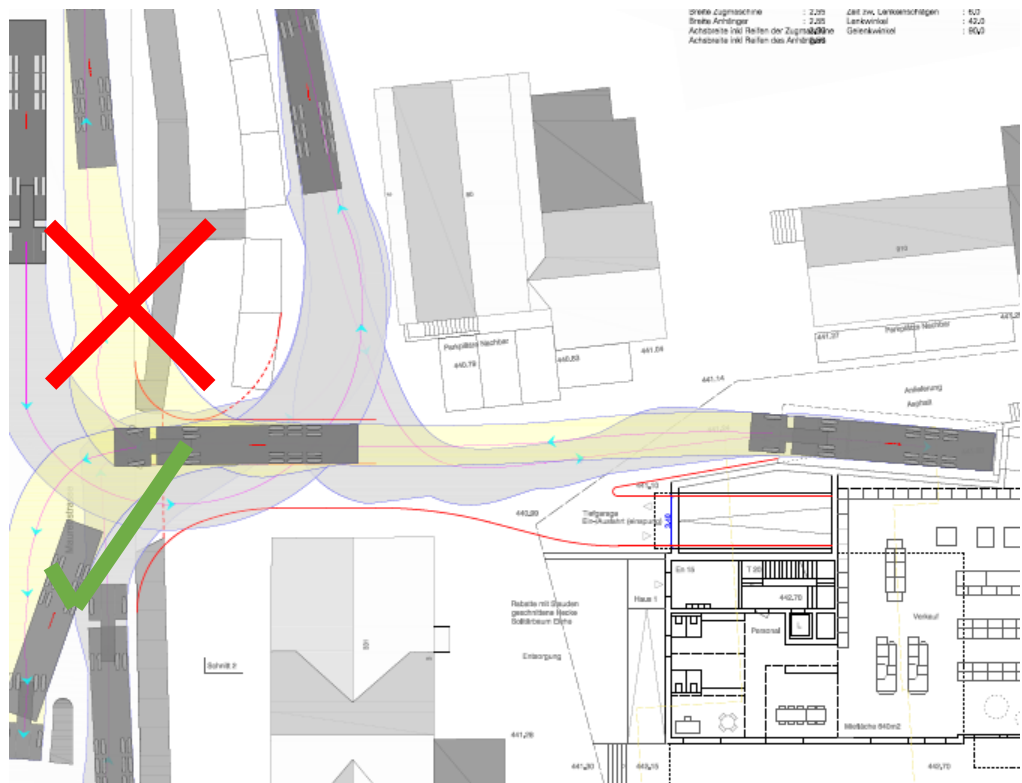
Ausschnitt aus dem Schleppkurvenplan (Nagel + Steiner, 2018). Die Wegfahrt nach Norden (rotes Kreuz) ist nicht möglich. Die Wegfahrt muss nach Süden erfolgen (grüner Haken).
